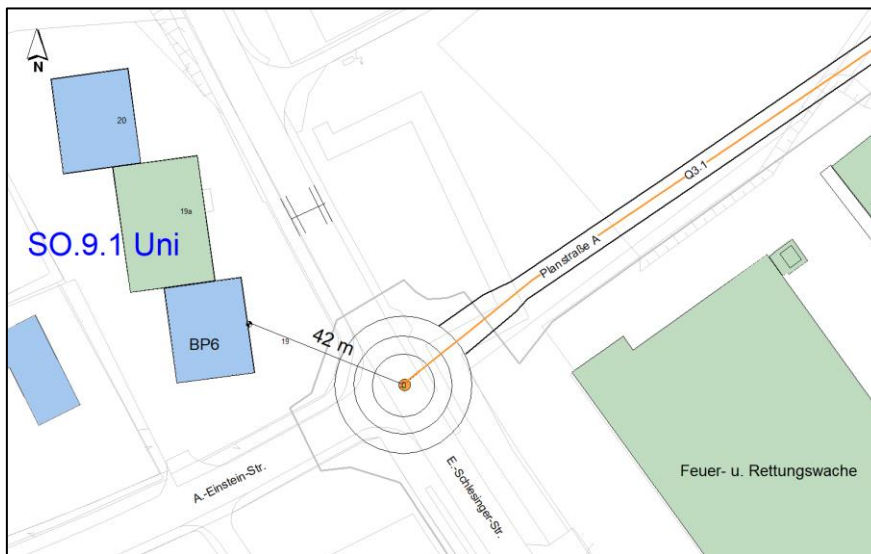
Neubau Planstraße A; Bereich Kreisverkehr E.-Schlesinger-Str.
